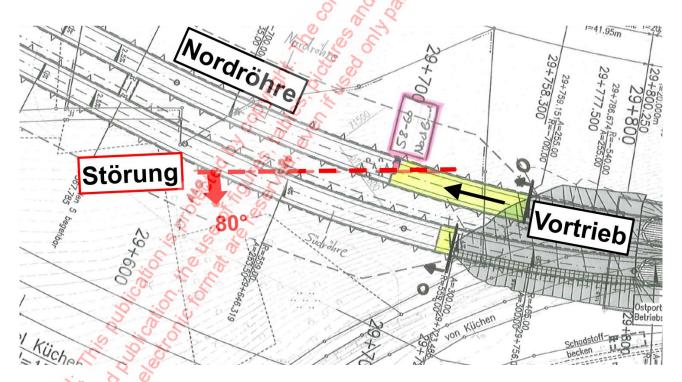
Störung im Bereich Tunnel Küchen, BAB A 44
